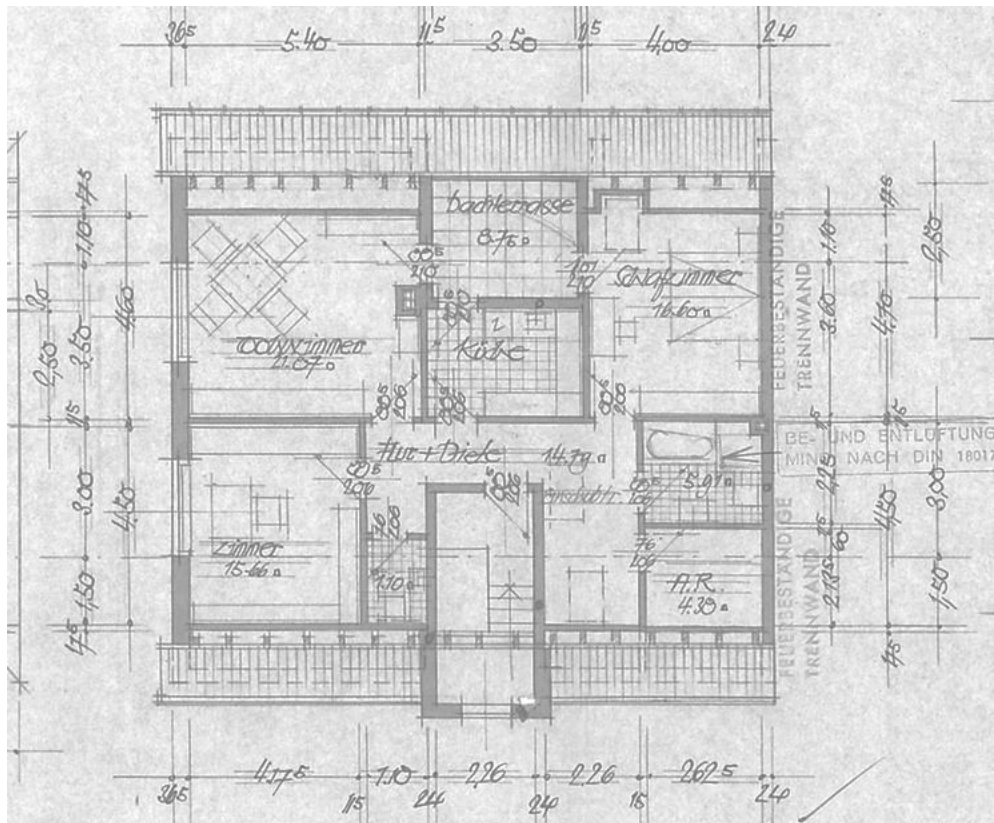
Grundriss Dachgeschoss Wohnung Nr. 5 - Bauplan 1983
